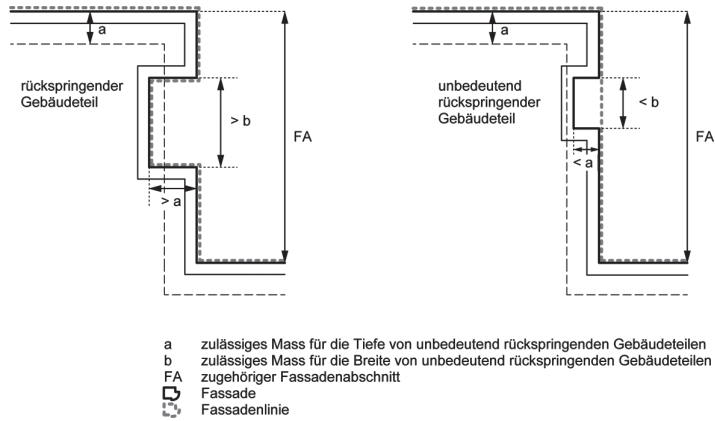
a Fassadenflucht und Fassadenlinie (in ebenem Gelände)
